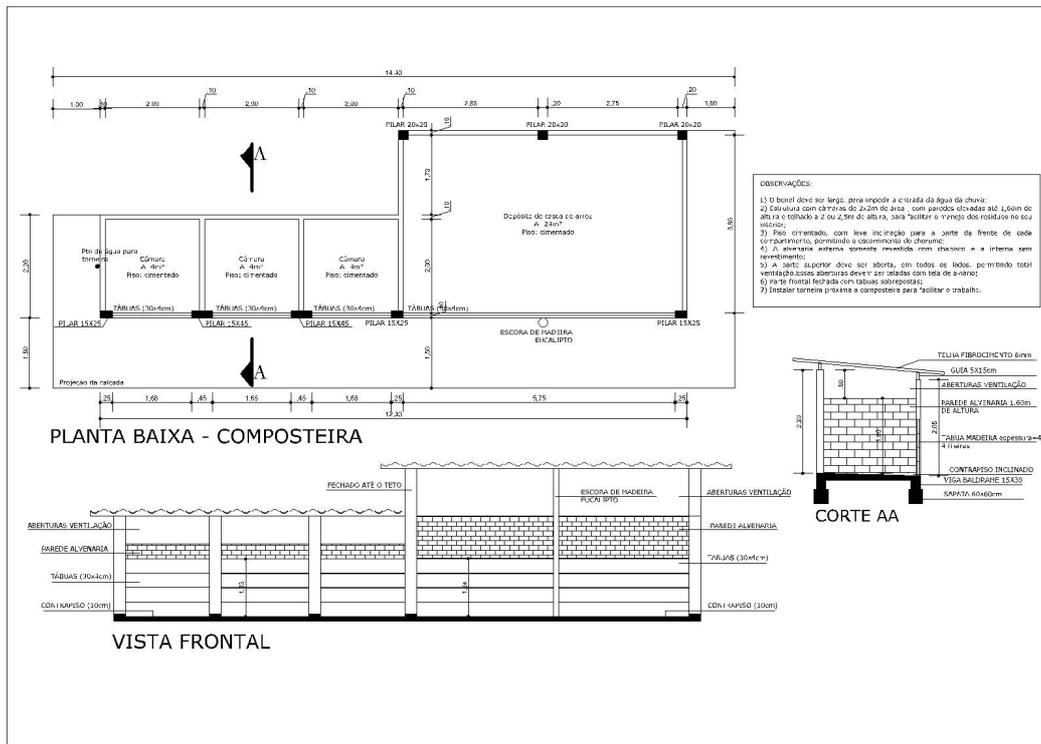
Planta baixa, vista frontal e corte da composteira de carcaças.
